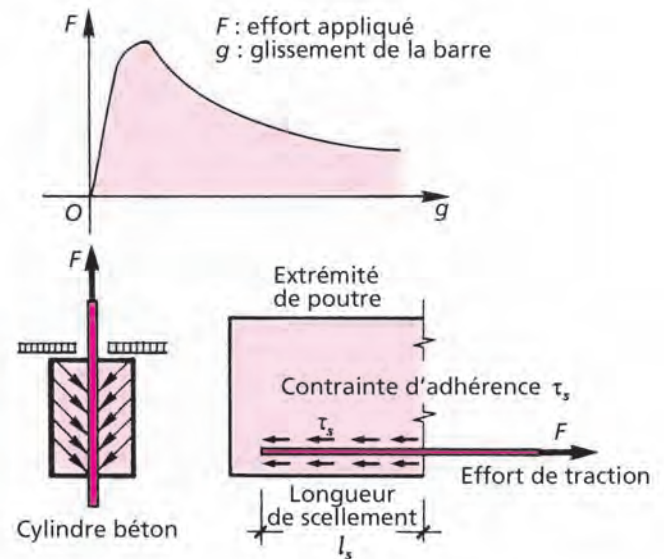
Adhérence et essai d'arrachement d'une barre
